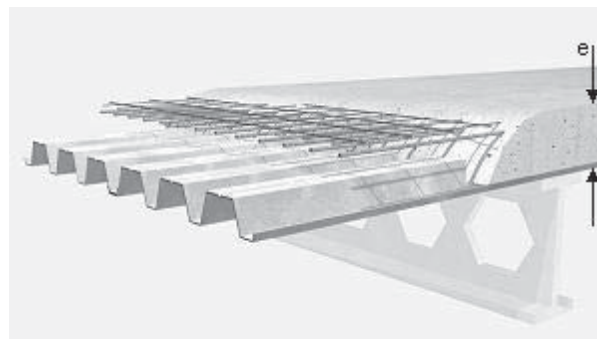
IMAGEN.- Losa acero, a base de láminas acanaladas, malla electro soldada, pernos y una capa de compresión de concreto.
